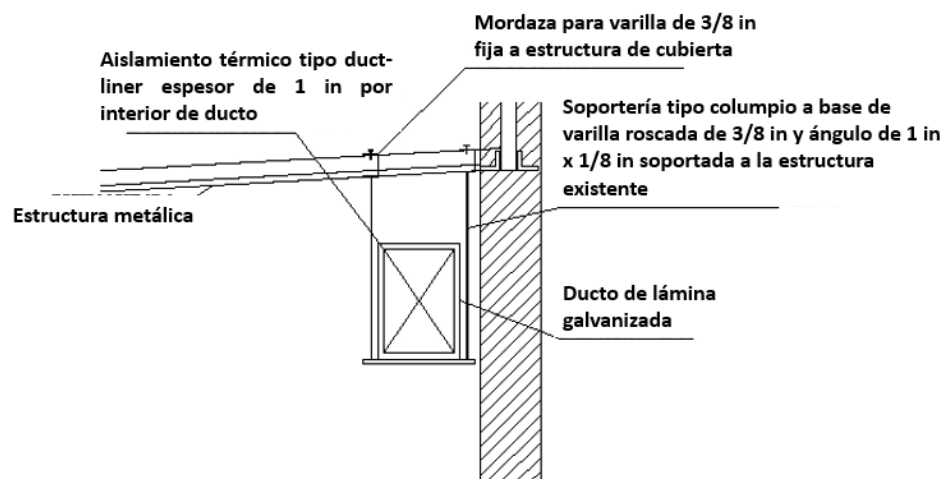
Detalle típico de montaje de soportería para ductos de A/C
